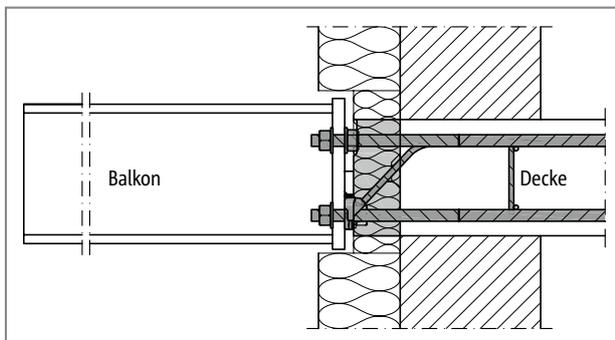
Schöck Isokorb® T Typ SK: Anschluss an die Stahlbetondecke; Dämmkörper innerhalb der Außendämmung
